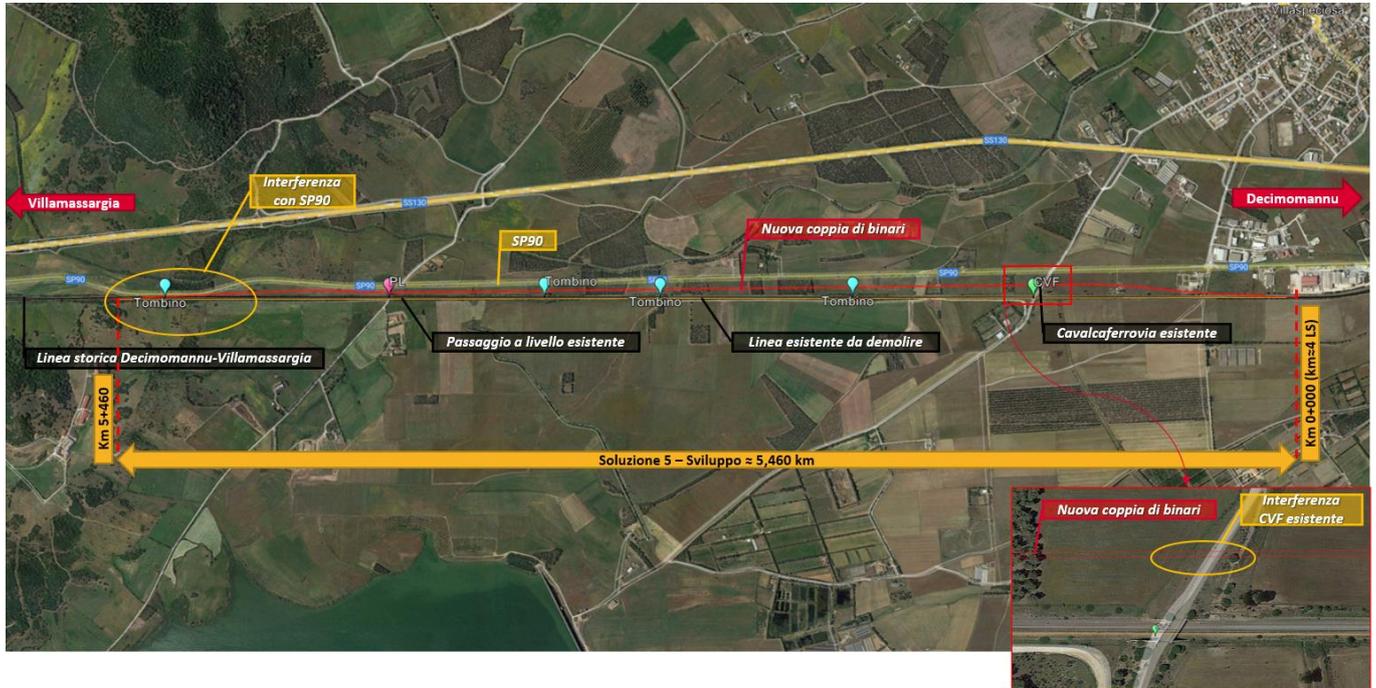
Planimetria soluzione 5 - raddoppio in variante a nord - configurazione finale nuova sede a doppio binario
